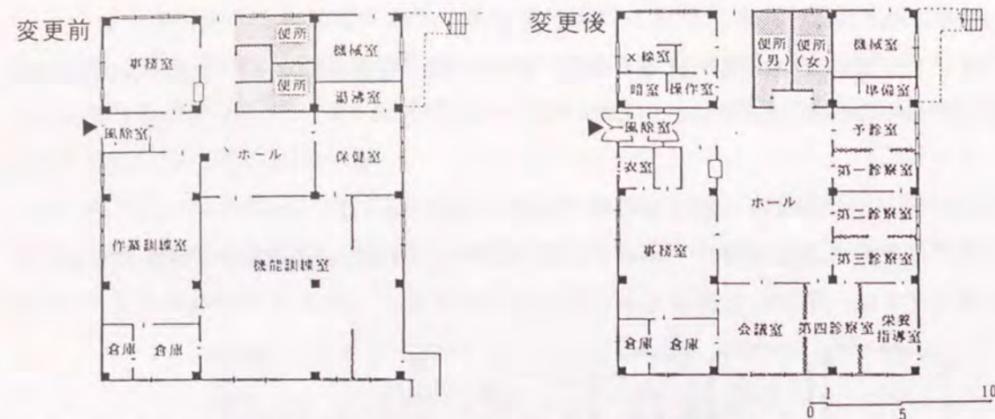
<94>足立区心身障害者福祉センター（旧保健相談所）平面図
